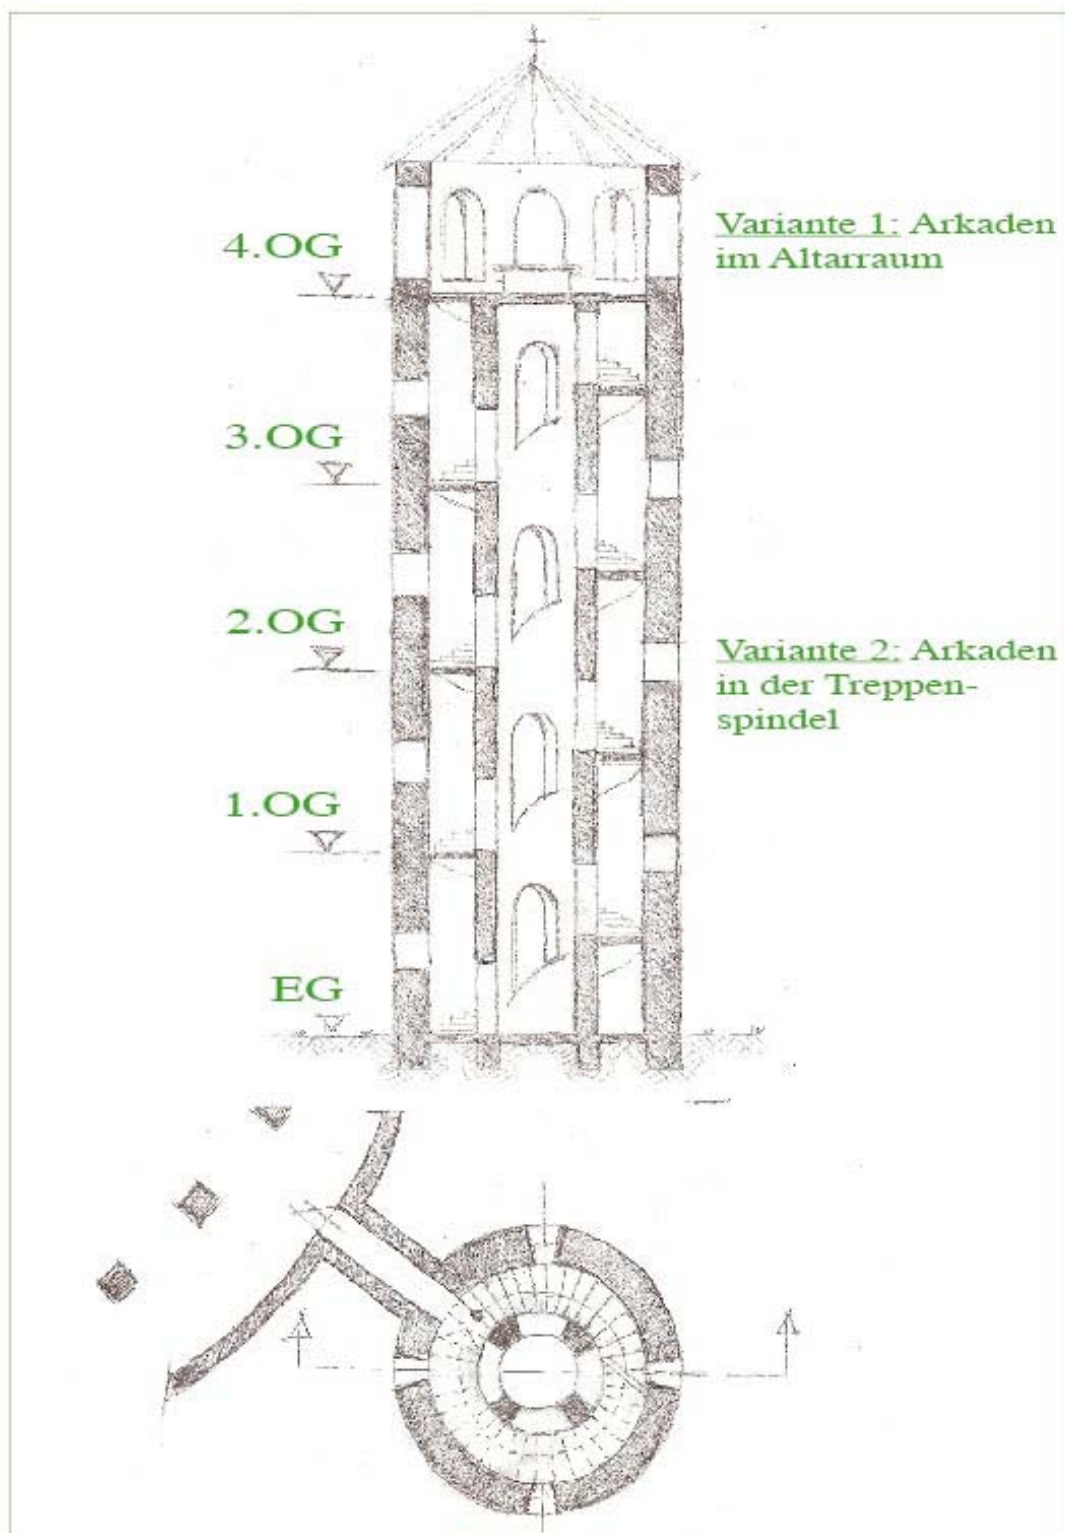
Südturm, Schnitt und Grundriss
